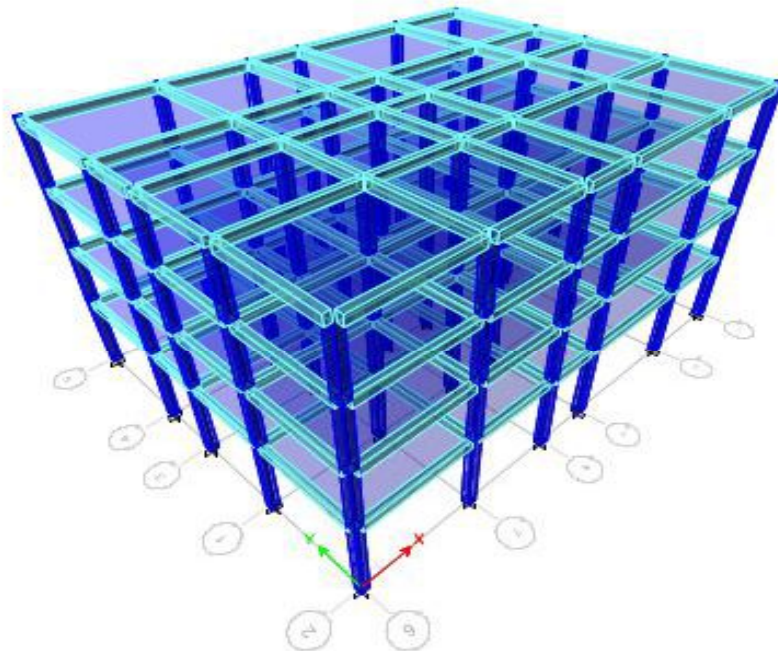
Modelamiento del sistema aporticado en Etabs V.13
